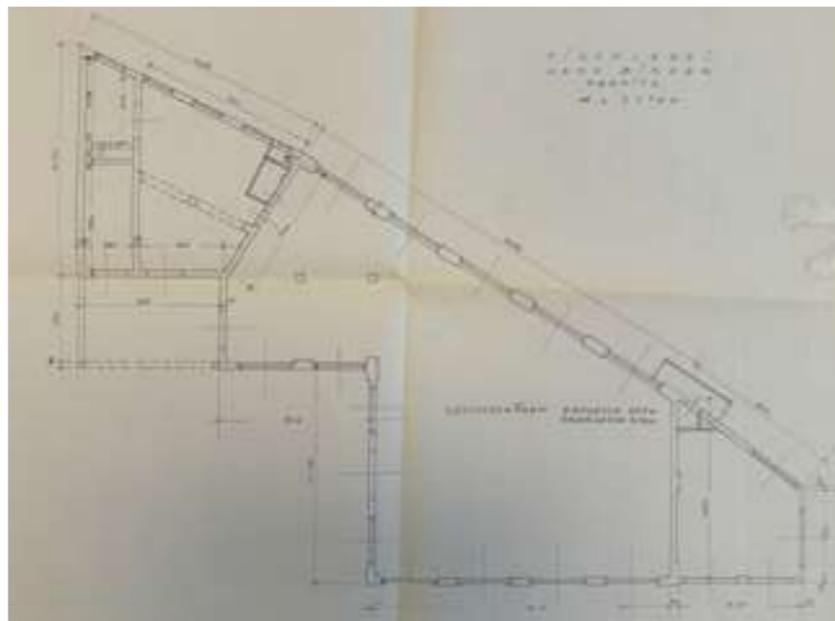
Grundriss Gebäudeteil 1 mit Gebäudeteil 2 und Zubau rechts, o. D.
